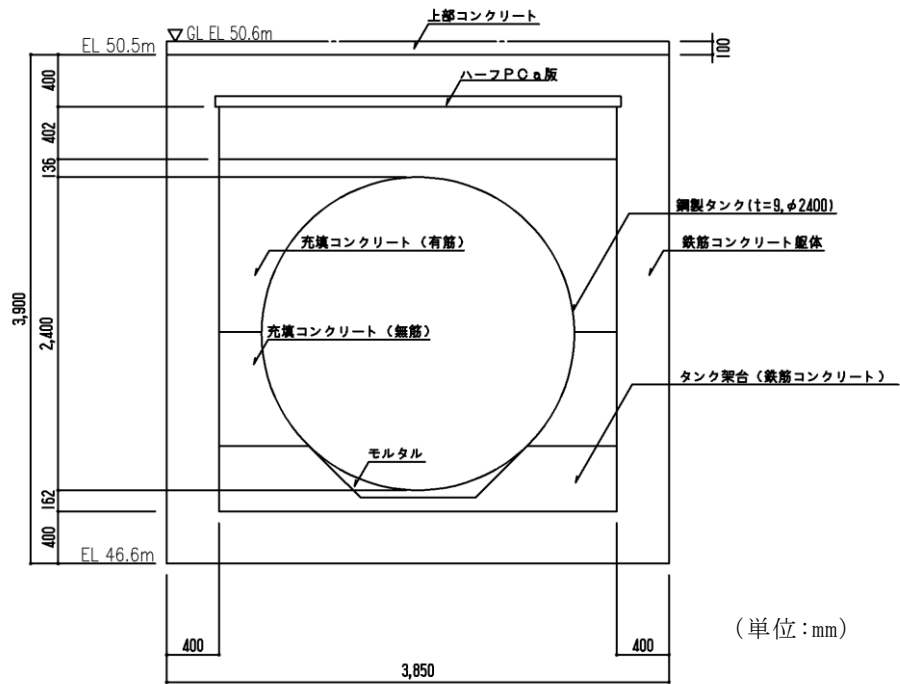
緊急時対策所用燃料地下タンク 断面図 (A-A 断面)
